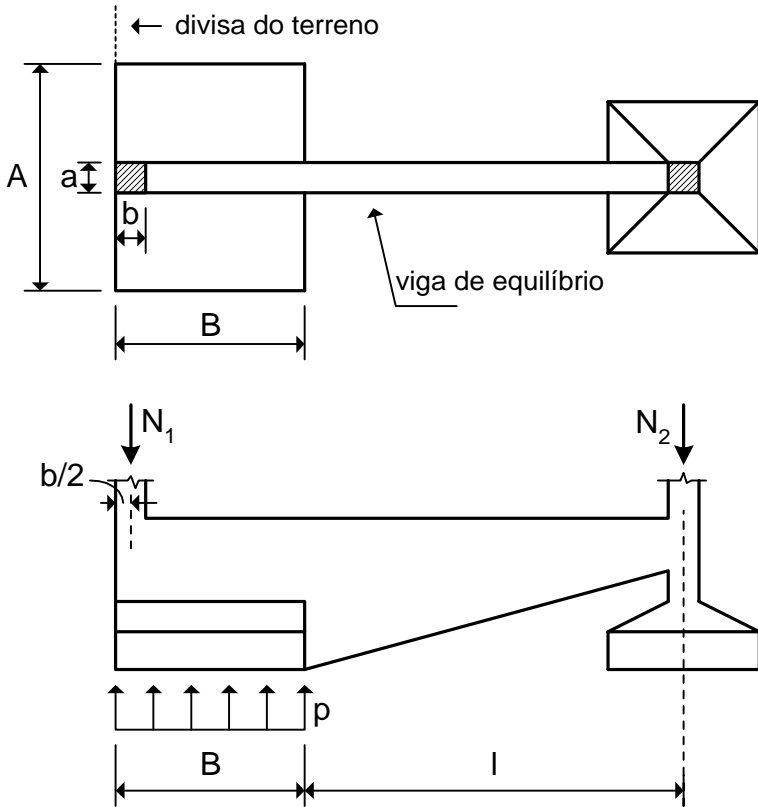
Sapata de divisa com viga de equilíbrio
